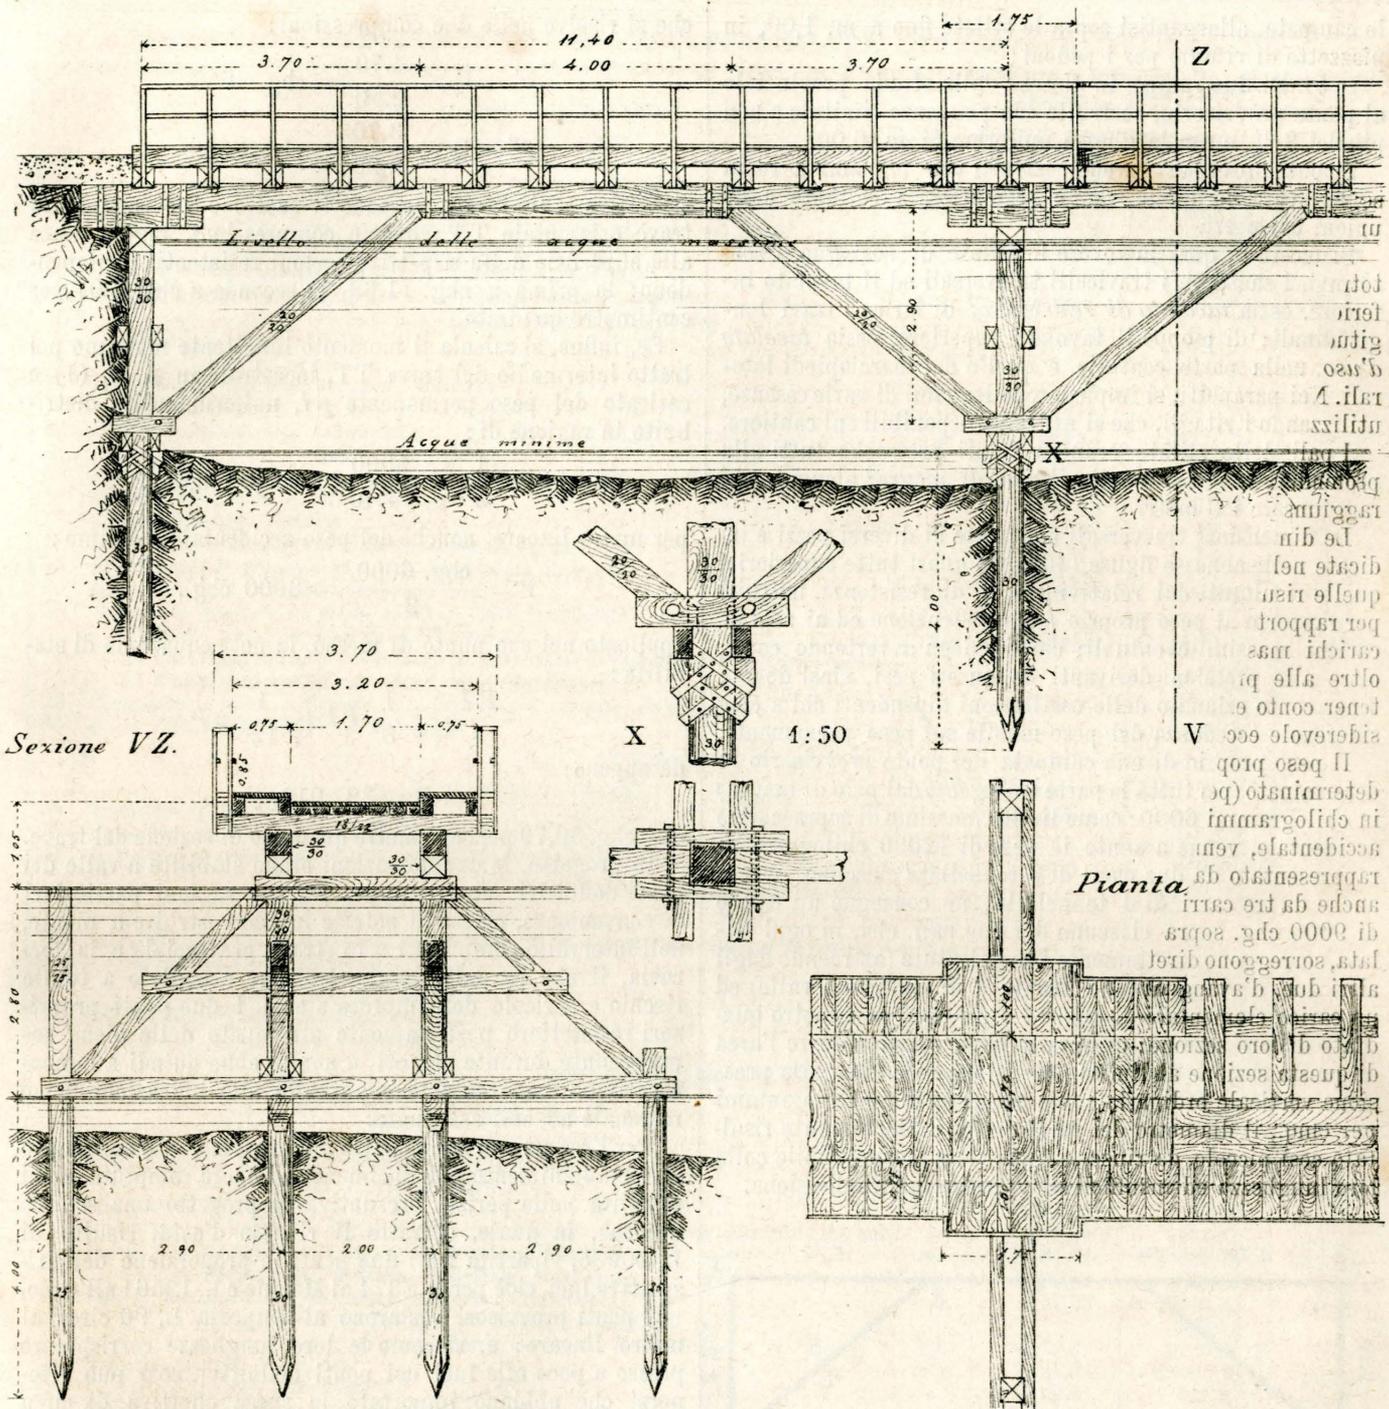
Prospetto, sezione trasversale e pianta del ponte provvisorio in legname.
